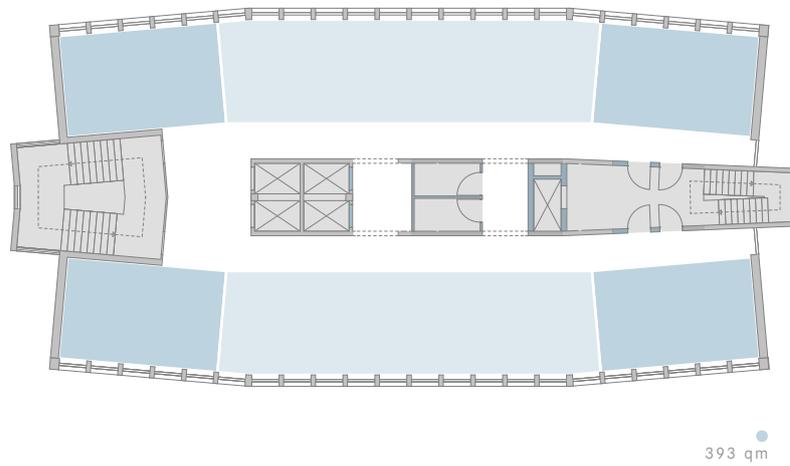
Grundriss Umbau - Nutzungseinheiten
